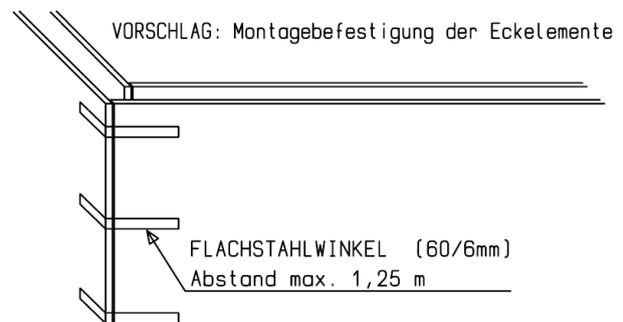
Flachstahlwinkel zur Ecksicherung [OBE16]
